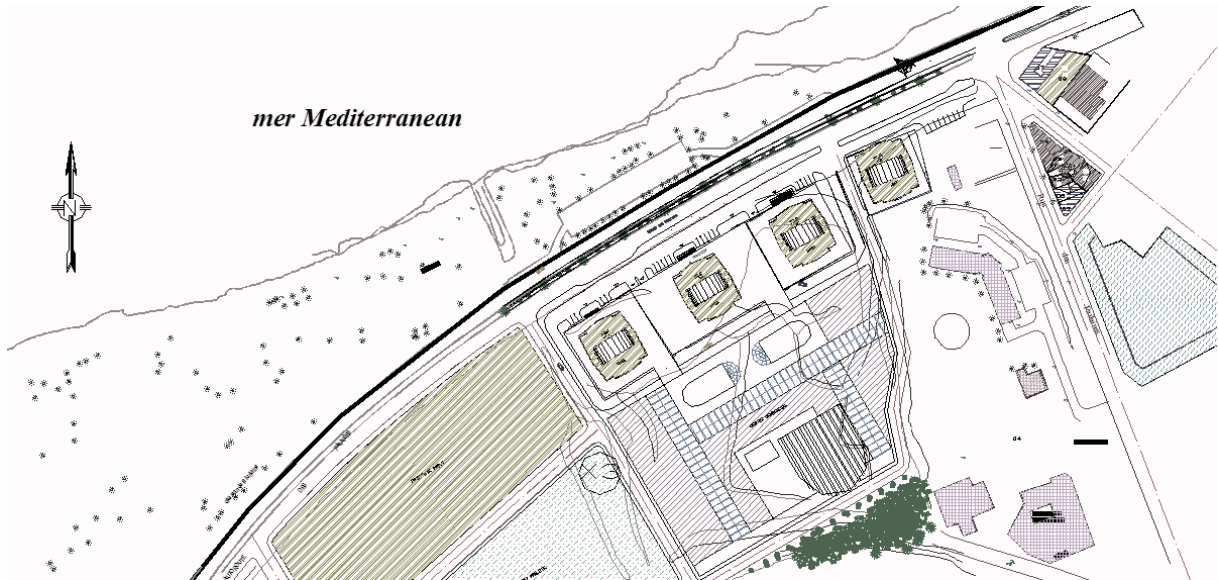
Plan de masse : ilot X3 (localisation du projet)
